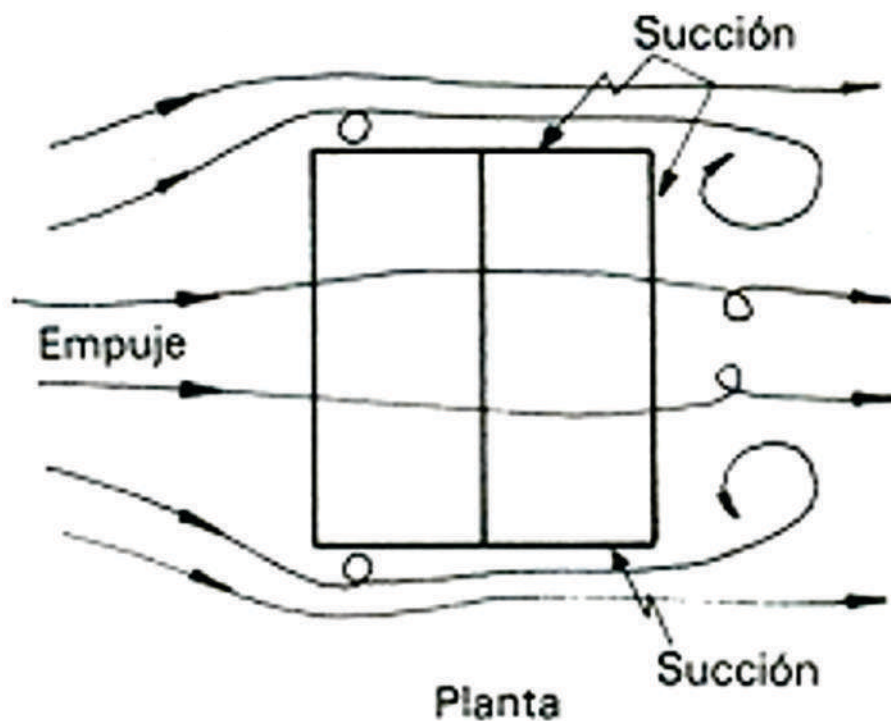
Configuración del viento alrededor de un edificio de planta rectangular.
